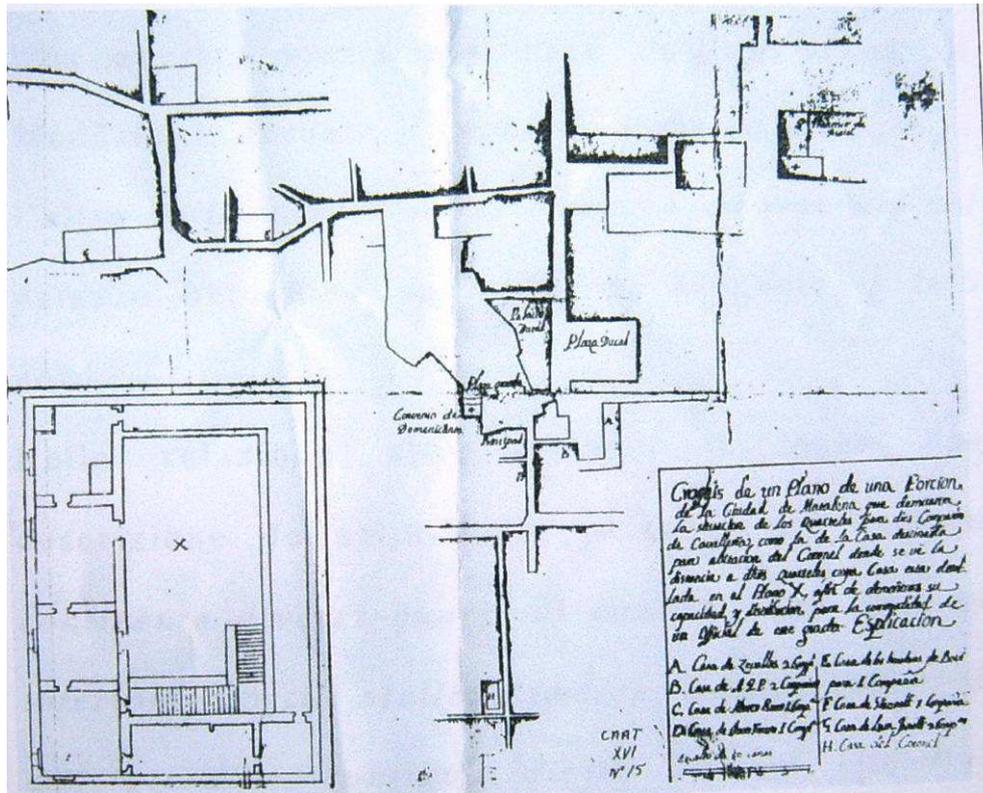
Maddaloni, schizzo planimetrico settecentesco, da R. Carafa 1992
